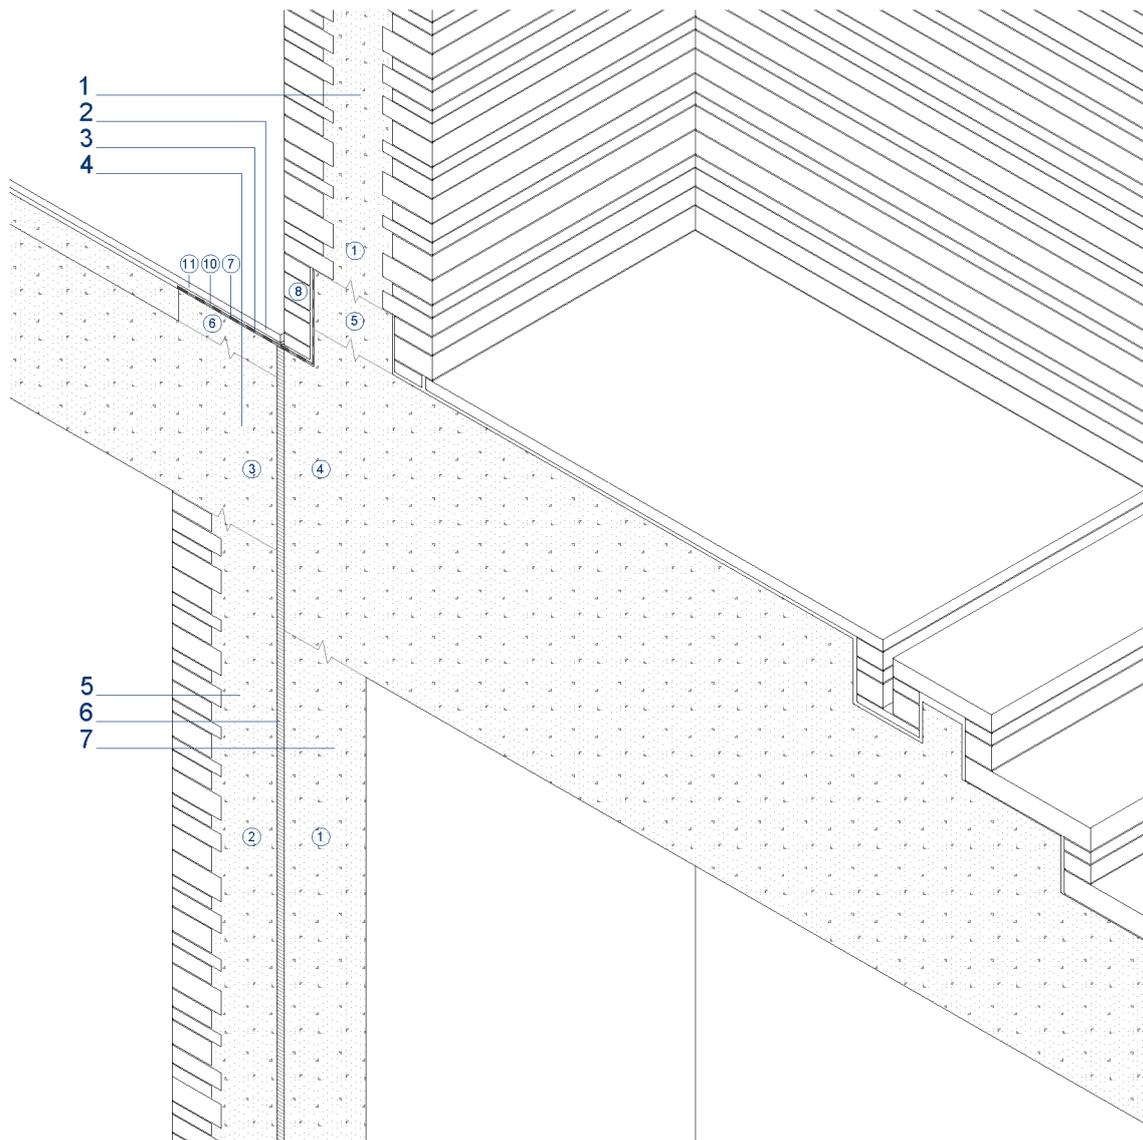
Axonometría E: 1/20. Detalle entre el muro y el forjado.
